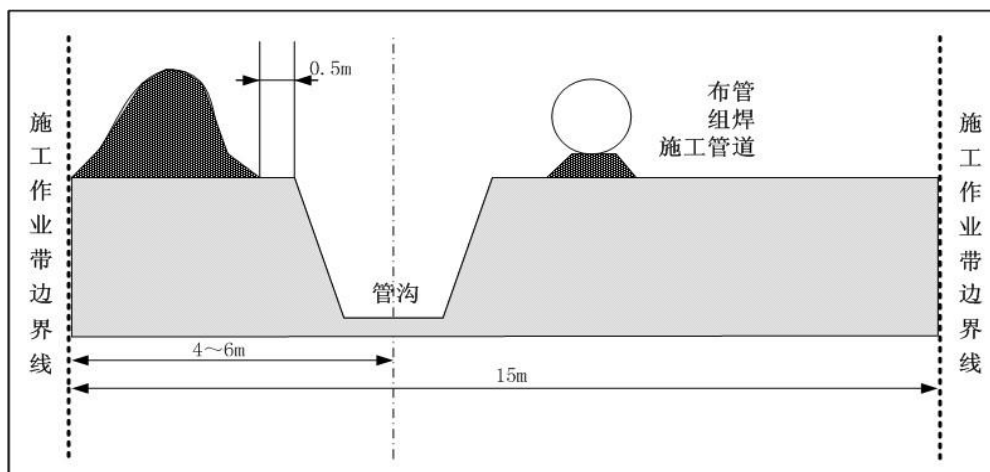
一般地段施工方式（开挖管沟）断面示意图
